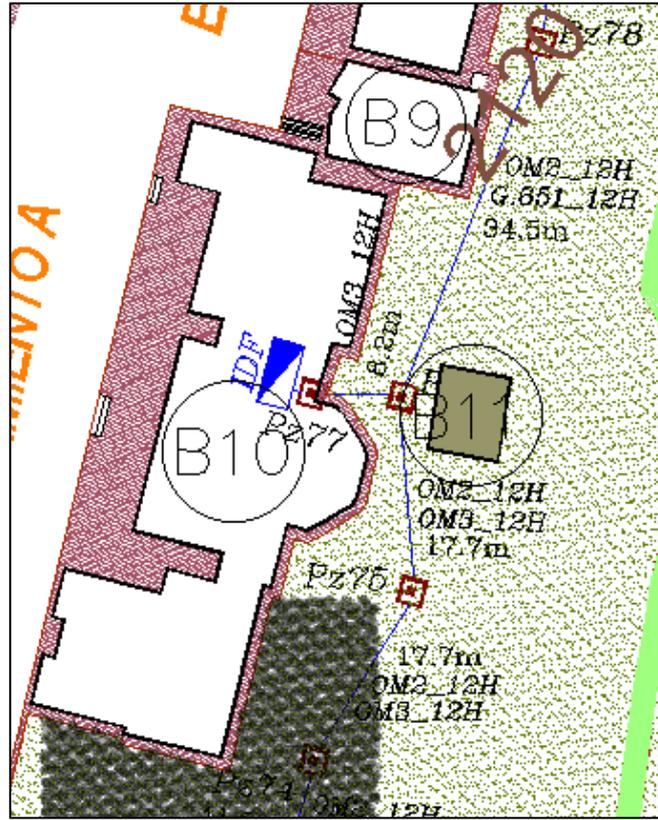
Planimetría del recorrido de fibra óptica existente bloque 10. (Autor, s.f.)
